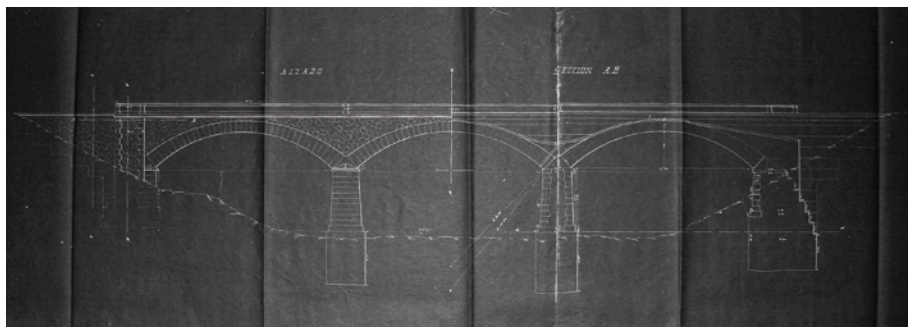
Plano de puente en mampostería en el río Gállego entre Molinaz y Santolaria.
